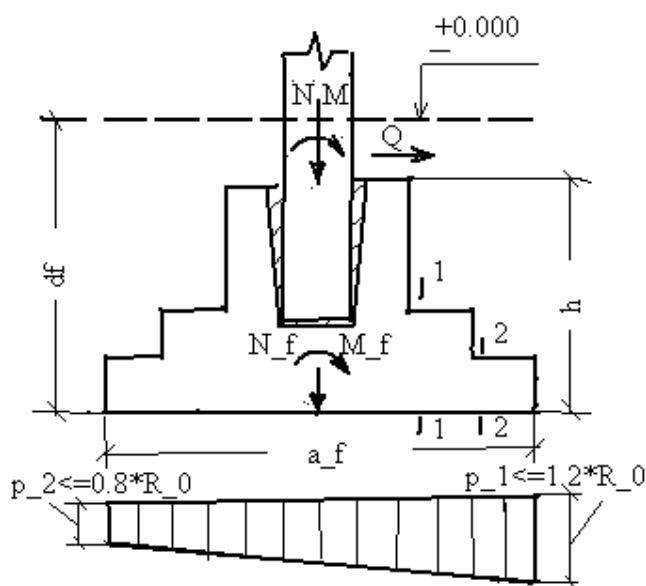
Схема расчета внецентренно нагруженного фундамента
